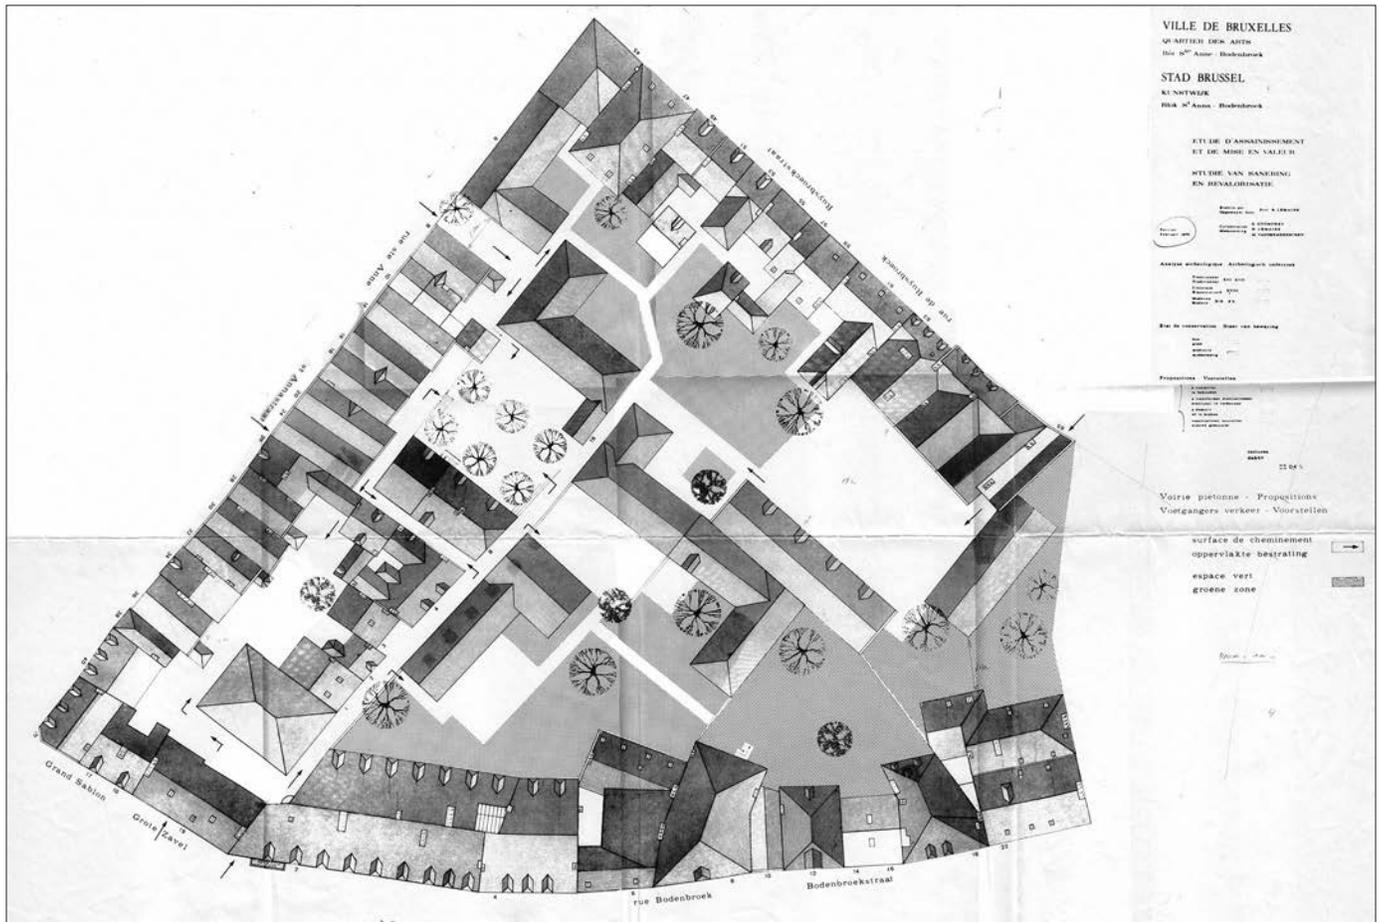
Proposition de plan d'assainissement de l'îlot Sainte-Anne, R. Lemaire et collaborateurs, février 1970, plans 356.9, ARML.
